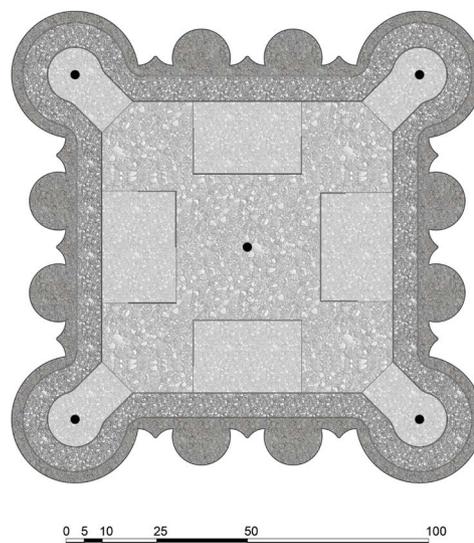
Detalle sección columna crucero Hugo Ventura Rodríguez.
